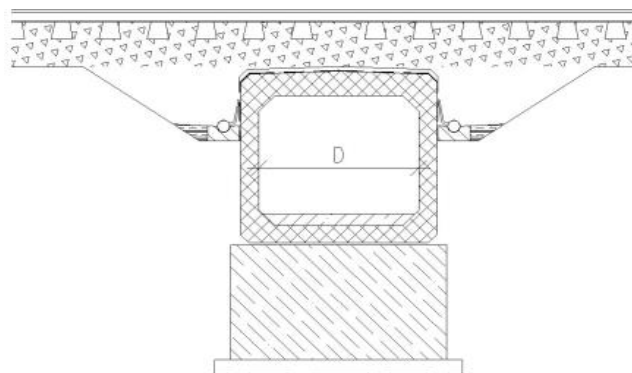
Exemplu de podeț realizat din cadre prefabricate din beton armat
